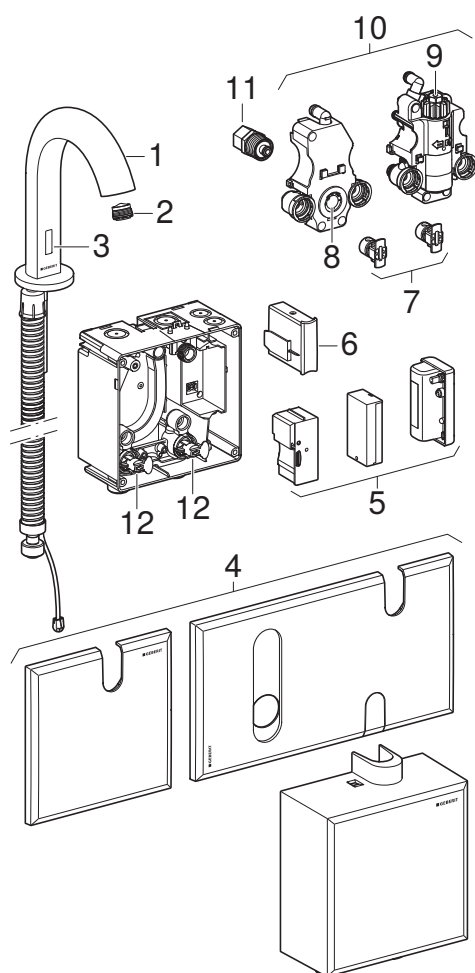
Rubinetterie per lavabo Geberit Piave e Brenta, montaggio a pianale
